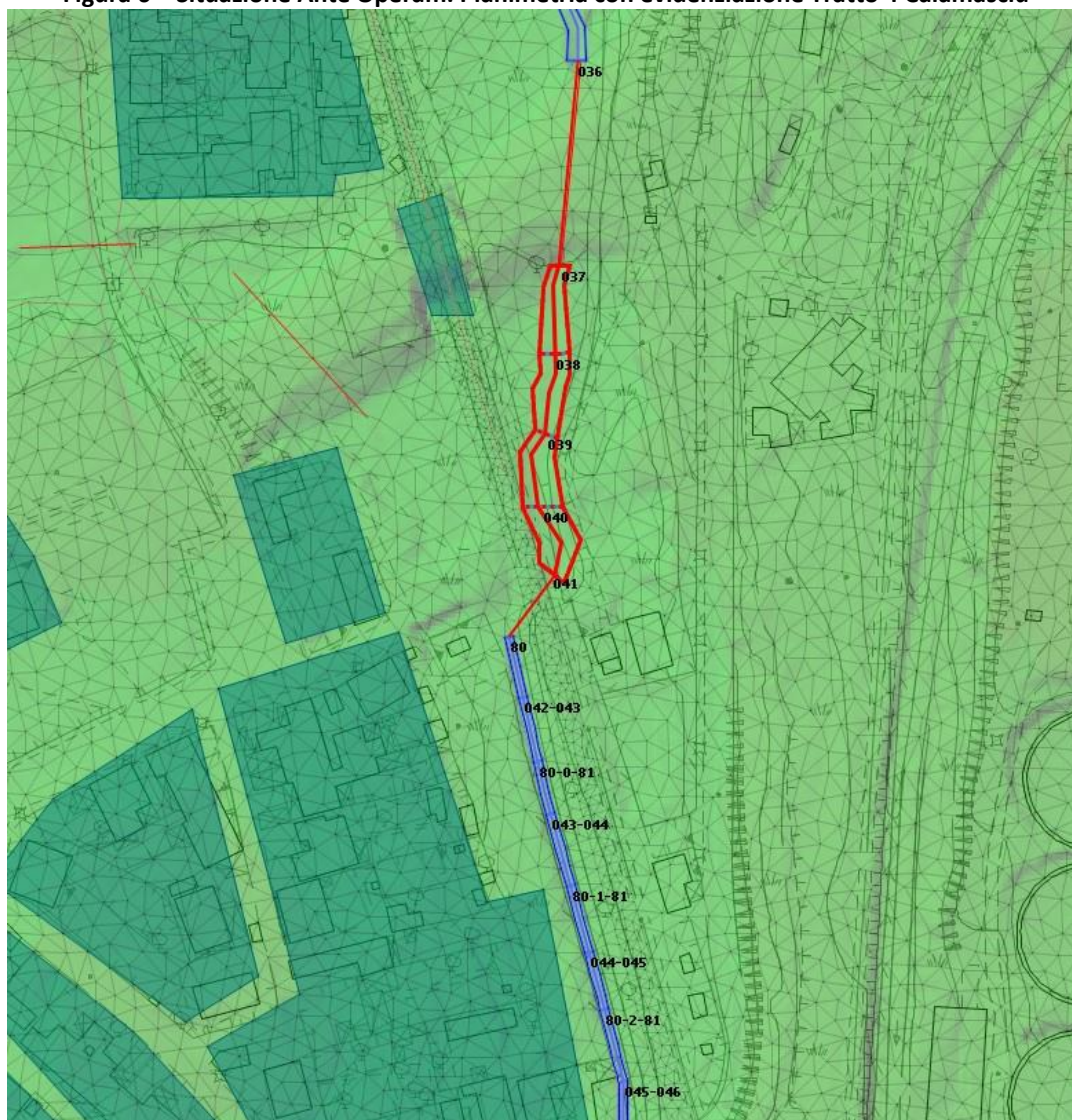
Situazione Ante Operam. Planimetria con evidenziazione Tratto 3 Calamasciu
